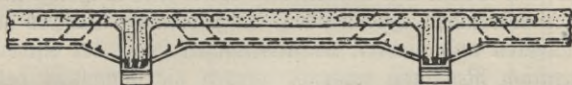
Kontinuierliche Plattenbalken zwischen Eisenbetonbalken bzw. Säulen.
